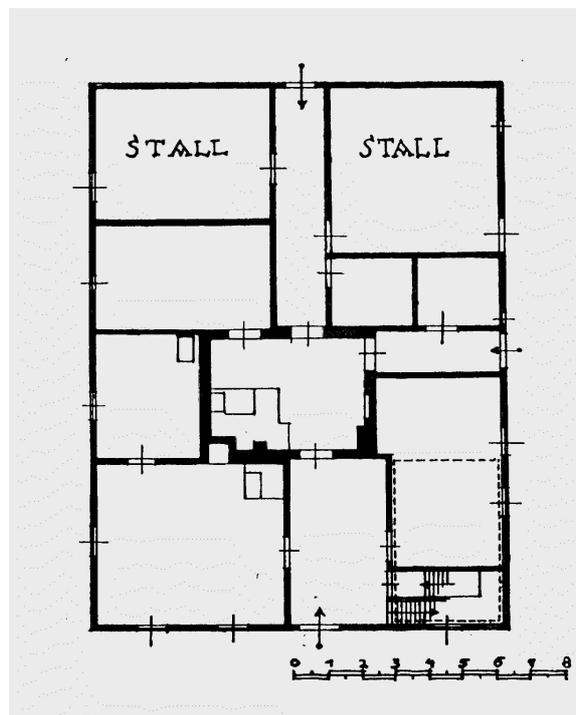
Grundriss des Wohnstallhauses Bralitz, Dorfstr. 9, erbaut 1809
